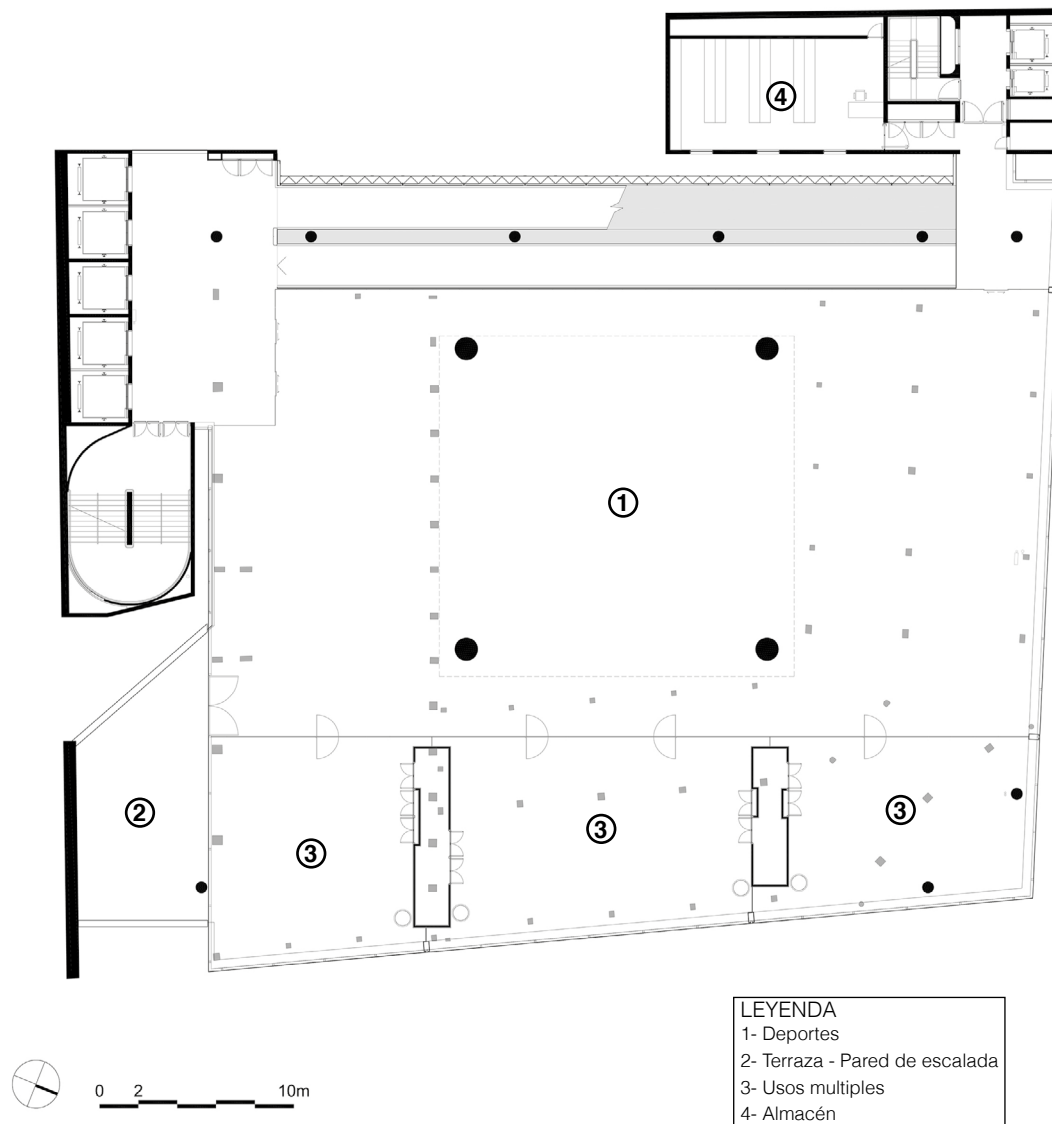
Planta Octava del Sesc 24 de Maio. (Autoría propia. 2021. Base: MMBB Arquitetos).
